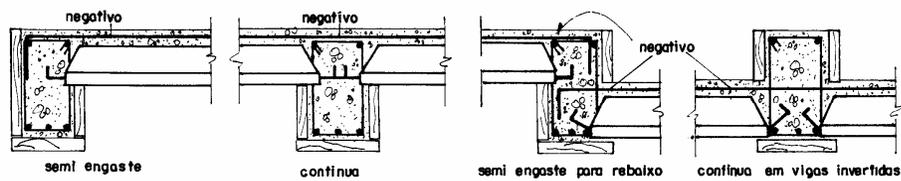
Apoio da laje comum em estruturas de concreto armado
